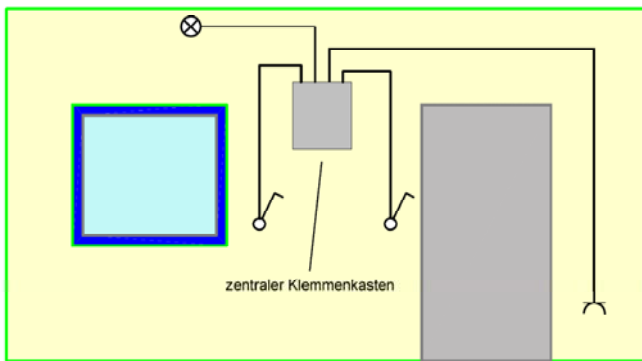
Installation mit zentralem Klemmenkasten²⁷
